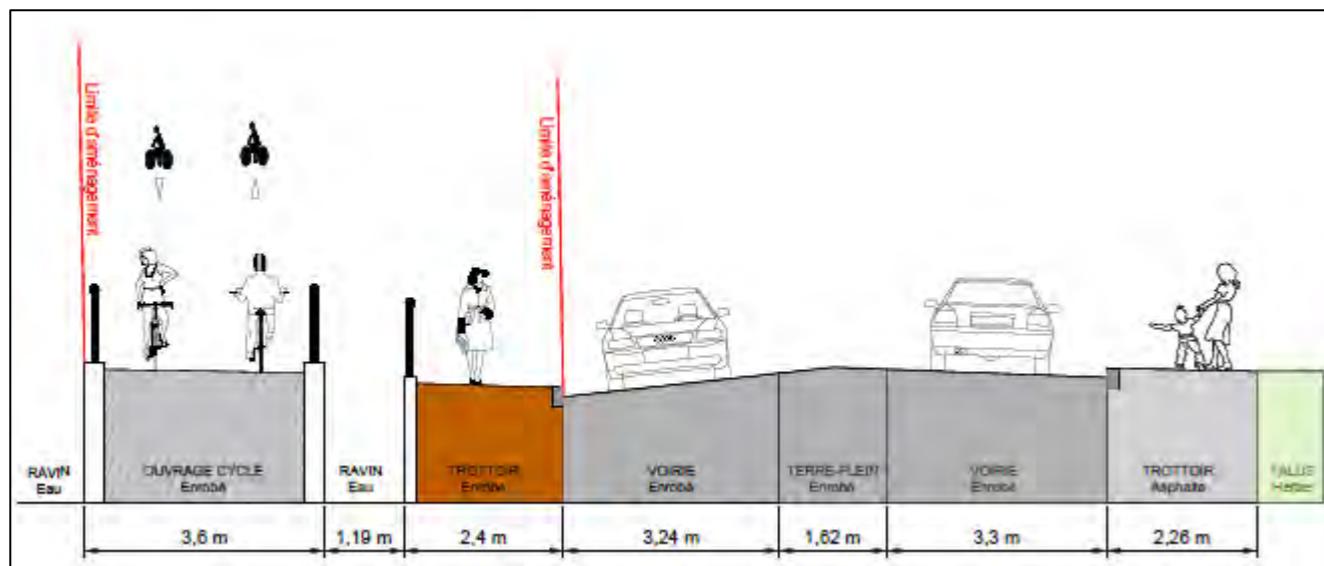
Avenue de la Prairie – Ouvrage de franchissement - Profil en travers projet - Setec / Signes-Paysages
